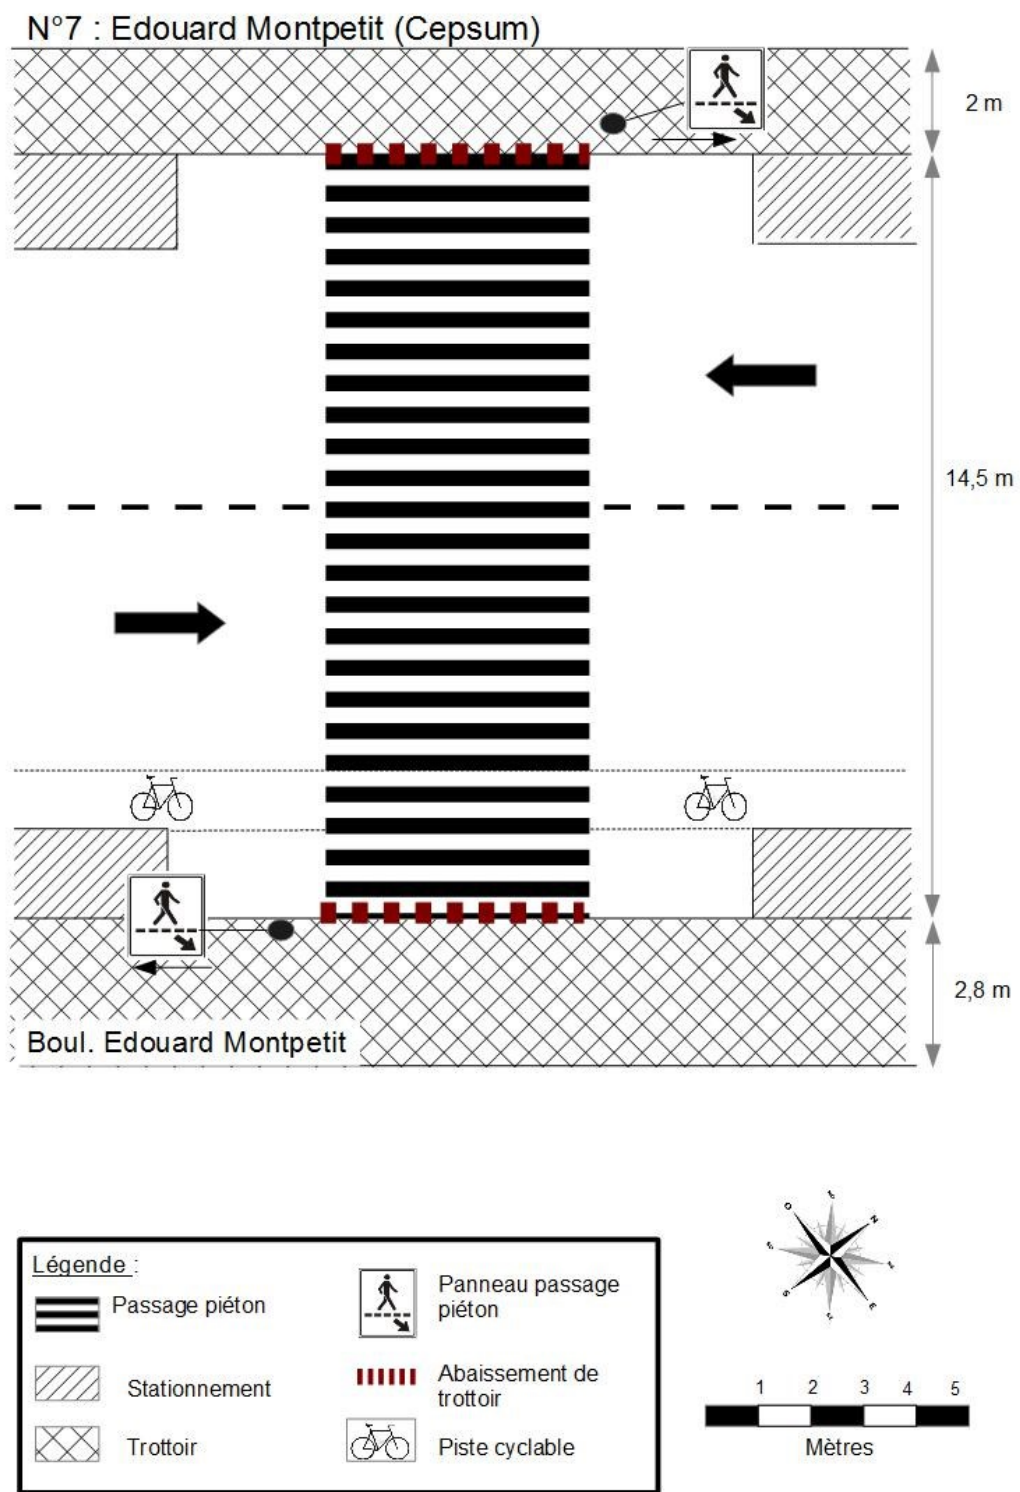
Site # 7 boulevard Édouard Montpetit (face Cepsum)
